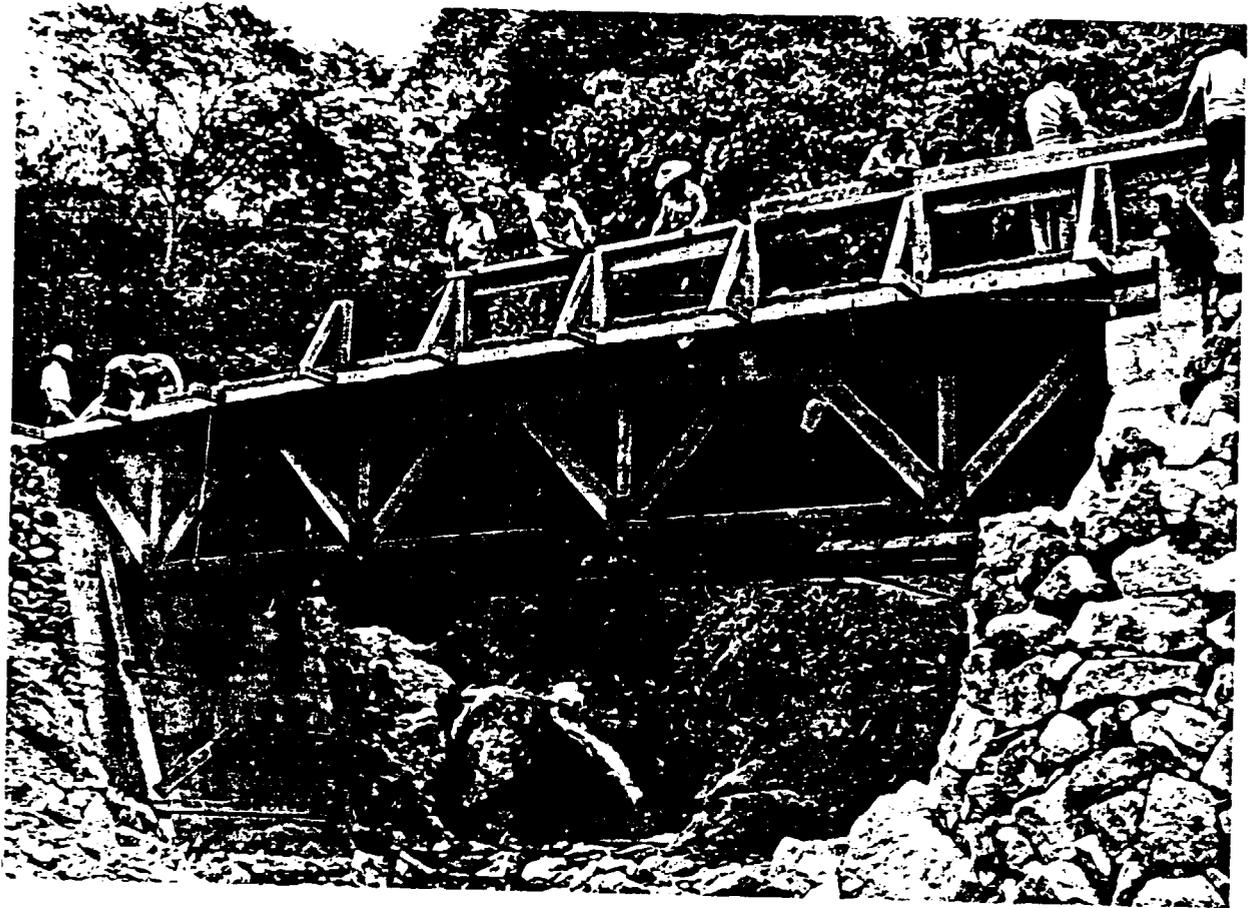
Panel del puente modular siendo levantado sobre la corriente, para ensamblarse como armadura. Nótese también la torre central sobre el río y la última vigueta en posición sobre los muros de concreto.
